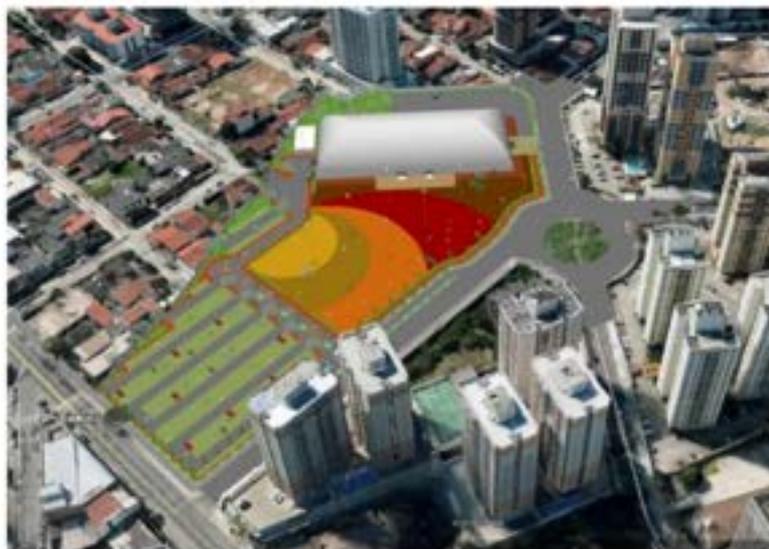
Vista aérea do projeto proposto pela Rua Ayrton Senna da Silva.
